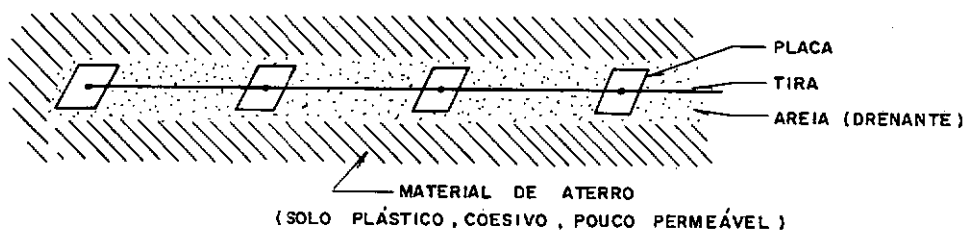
Produto Final do Elemento de Reforço com Plaque
